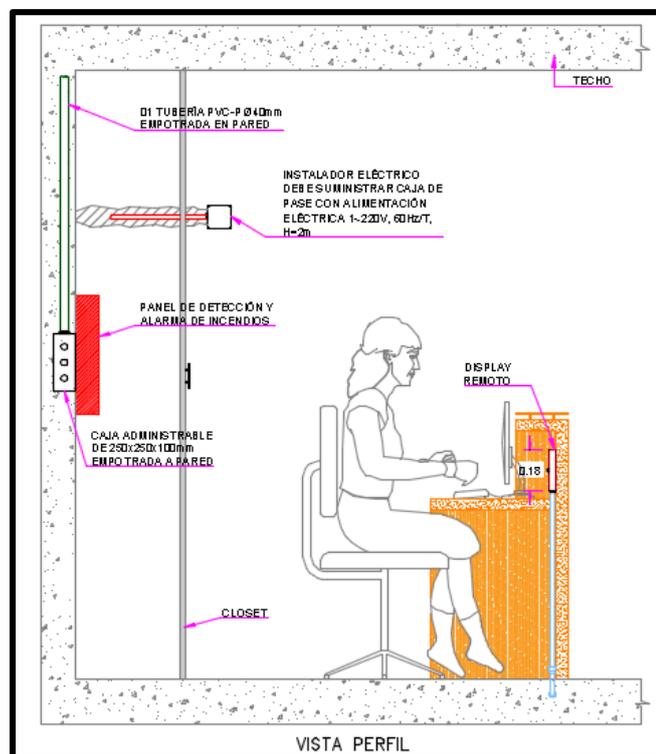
FACP y Display Remoto en Plano de Detalles (Vista Perfil)
